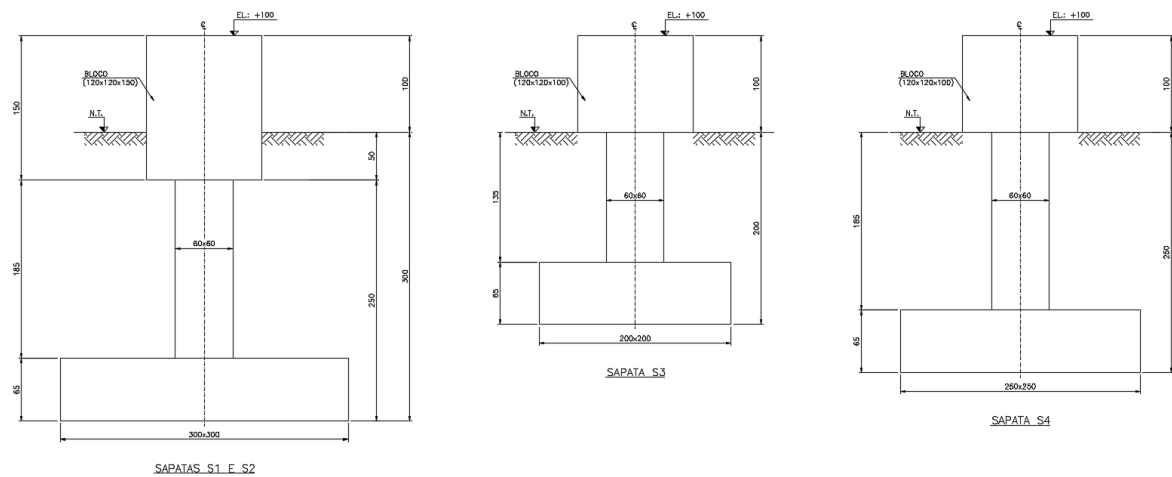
Geometria das Fundações Superficiais – Sapatas
